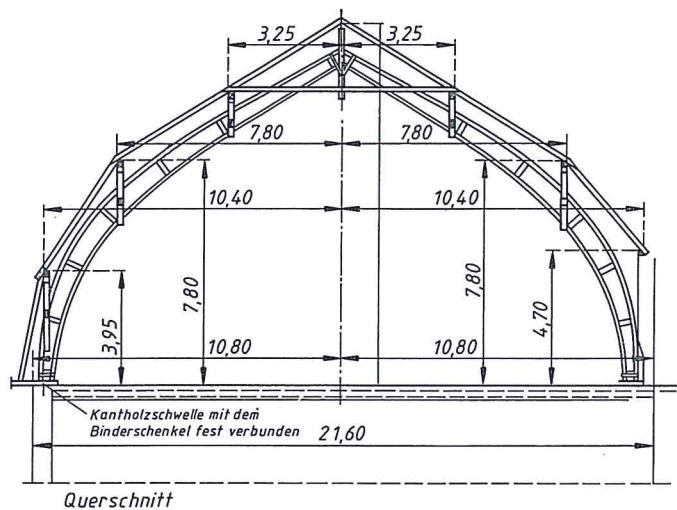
Träger für die Dachkonstruktion eines Stallgebäudes in Klebebauweise nach O. Hetzer,
